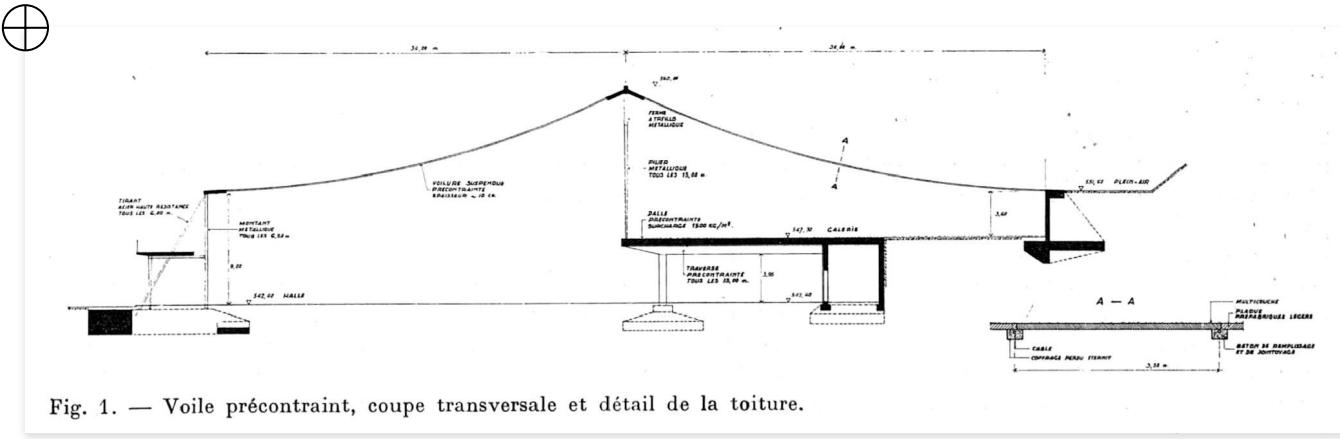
Voile précontraint, coupe transversale et détail de la toiture.
